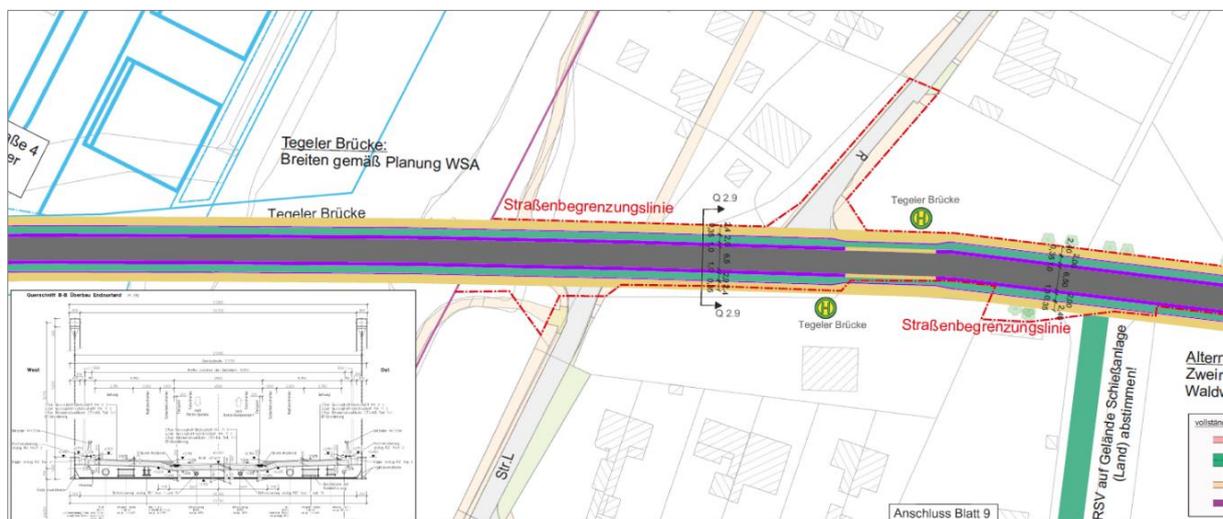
Neubau Gartenfelder Straße mit Tegeler Brücke sowie Anschluss Bernauer Straße
